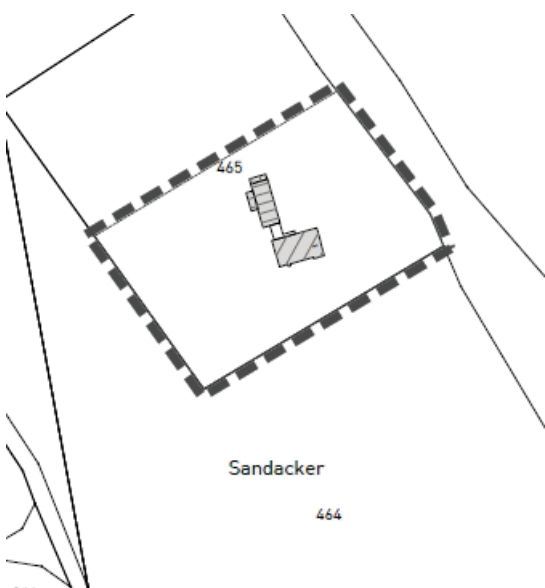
Ausschnitt aus dem Abgrenzungsplan werden.
